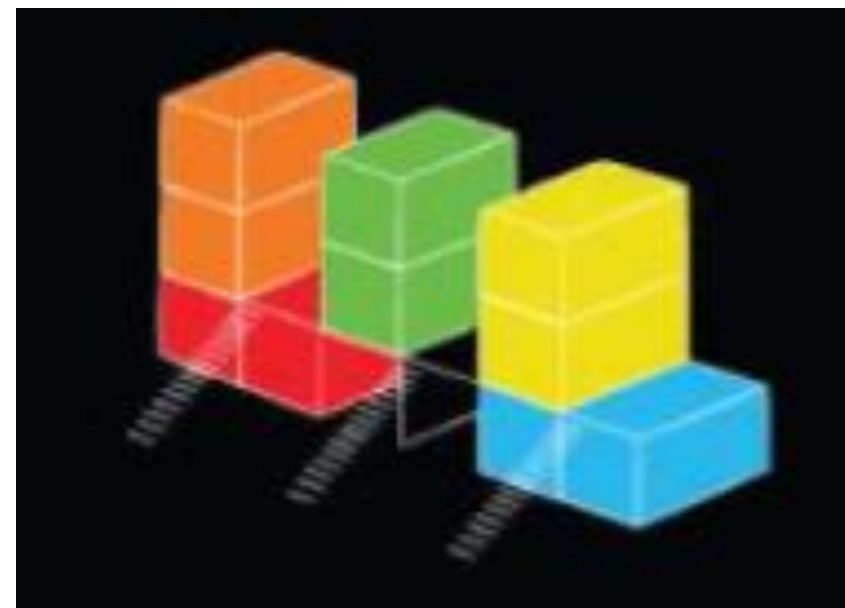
Proyecto Quinta de Monroy– Vista del proyecto final y habitado
